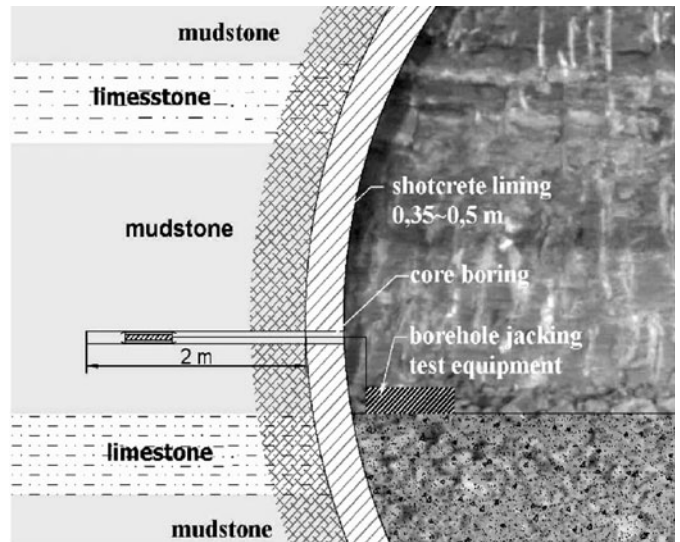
Versuchsschema der Messungen im Fasanenhoftunnel Stuttgart
